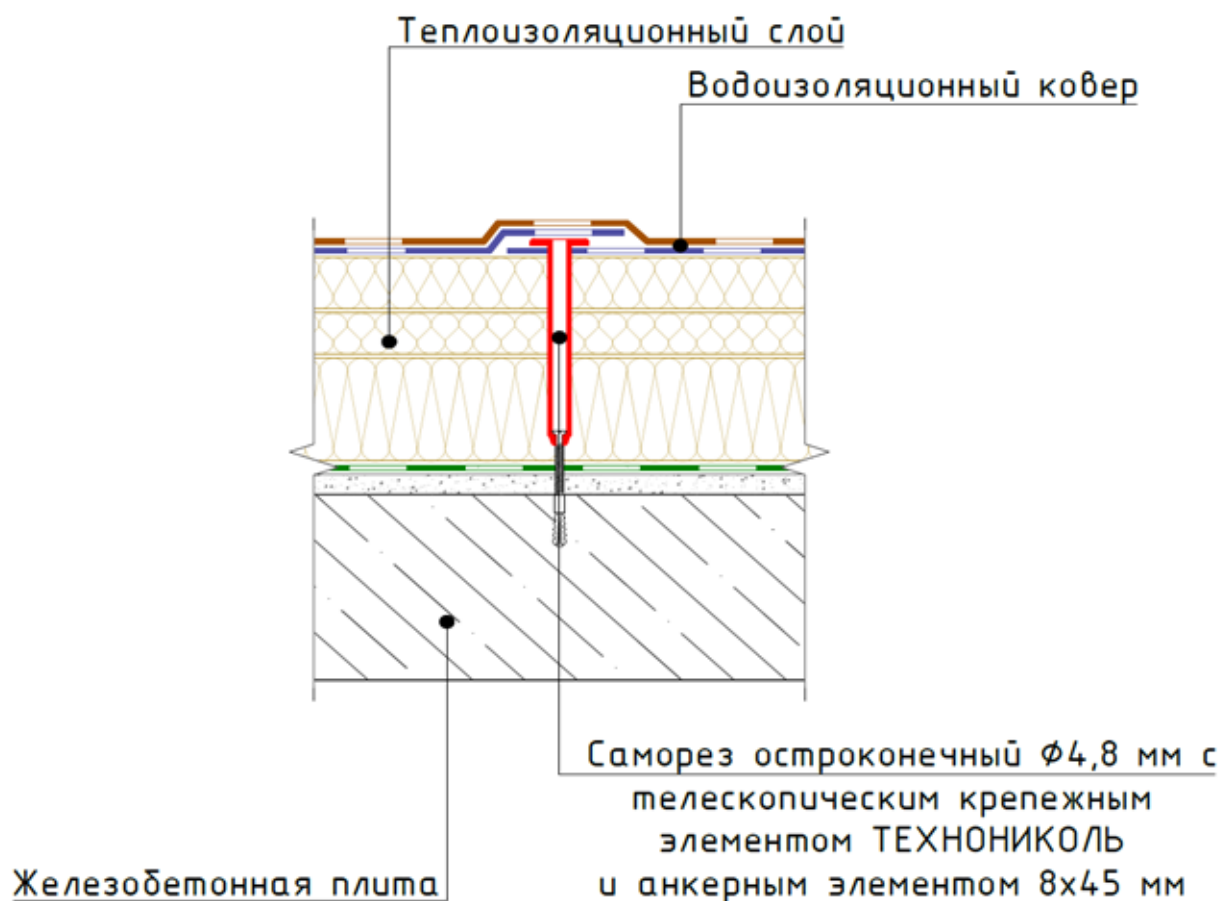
Крепление теплоизоляционного слоя и водоизоляционного ковра к железобетонному основанию
